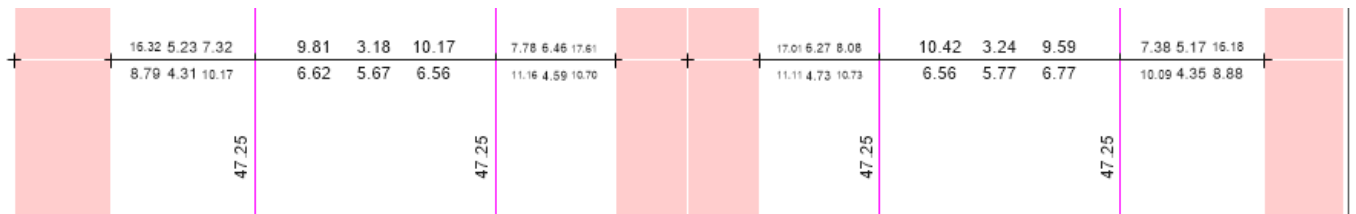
Acero Requerido por momentos en Vigas 5° Piso
